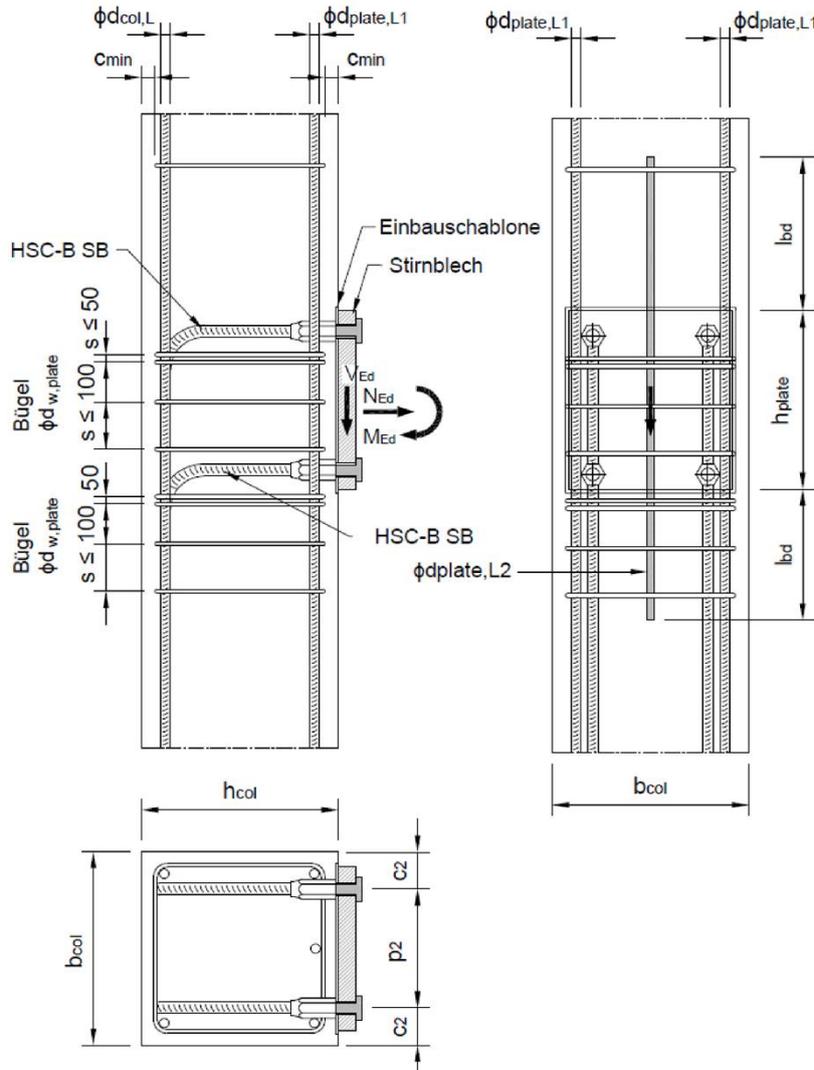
Dimensionierung und bauliche Durchbildung von Stirnblechanschlüssen mit Bewehrungsstoß
